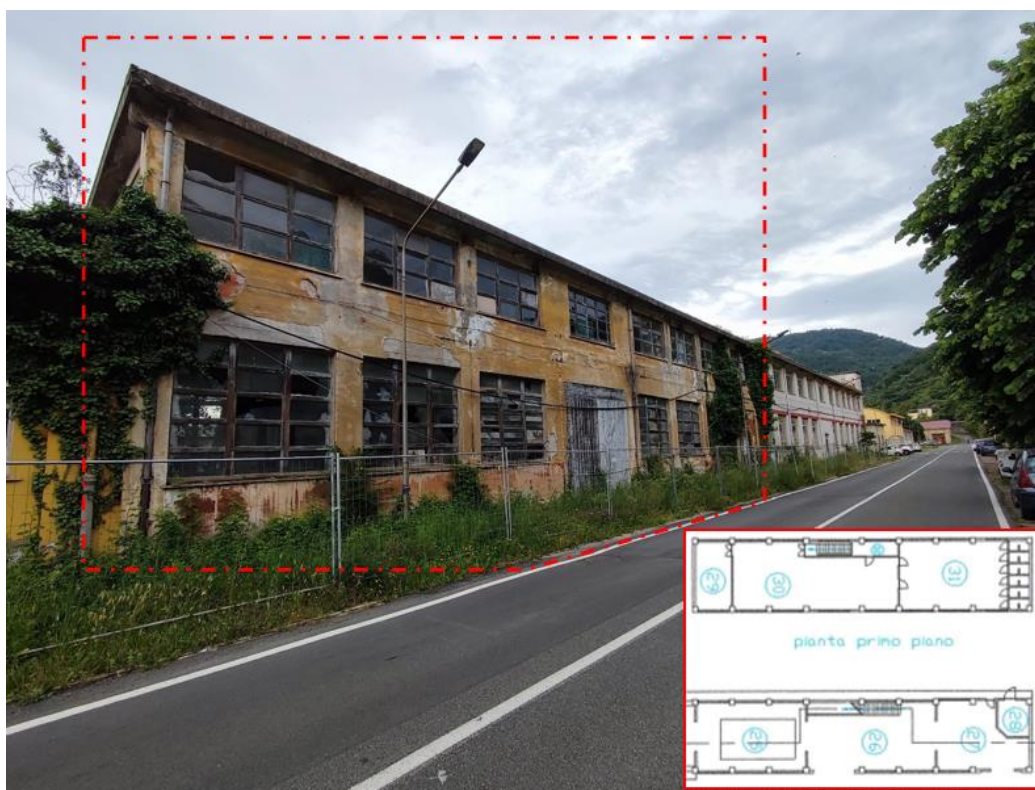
Fabbricato 152 (Corpo 1) - Prospetto fronte strada
